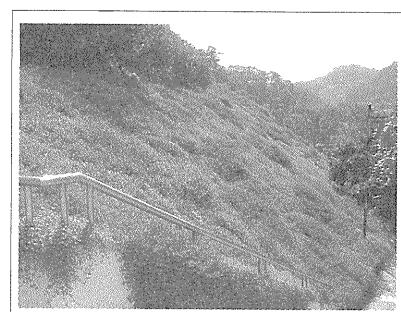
公園での施工事例（全面被覆、雑草の発生は少ない）
